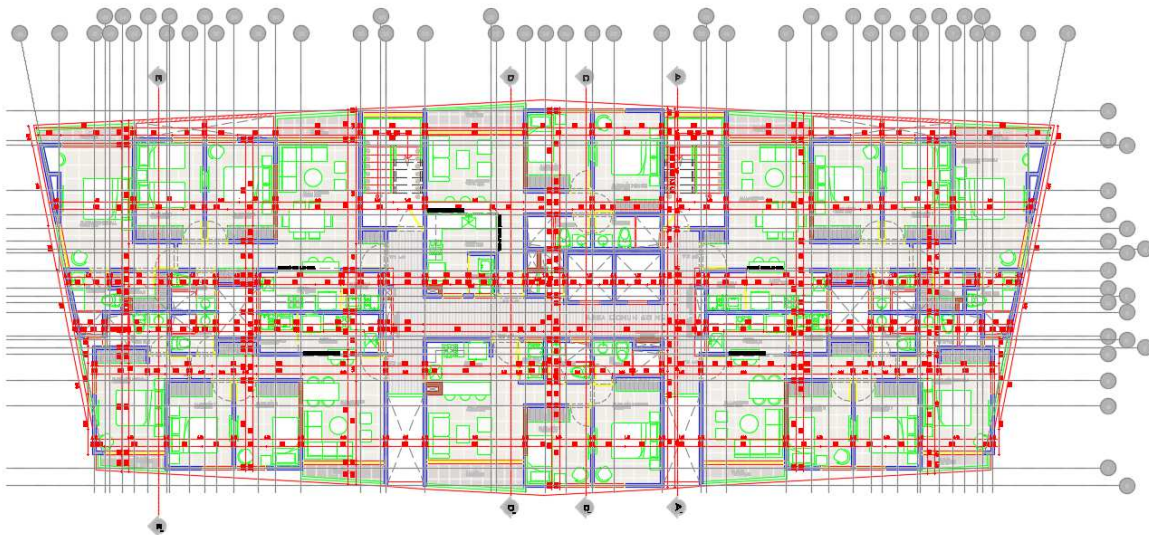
Planta arquitectónica Típica. Fuente: Diseño arquitectónico.
